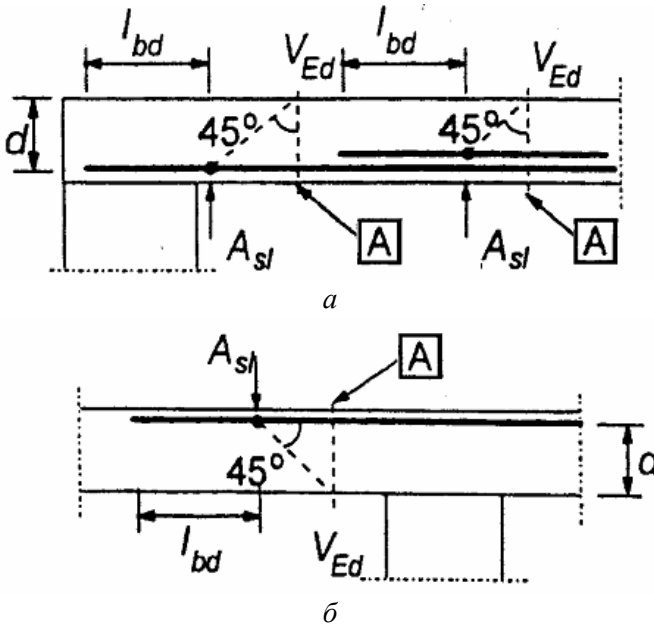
До розрахунку похилих перерізів: *a* – за умови вільного опирання; *б* – для проміжних опор нерозрізних балок [2, рис.4.6]:
